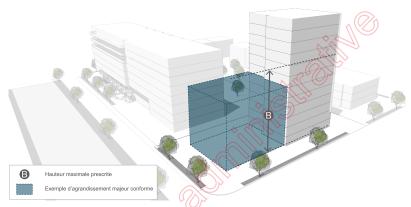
Agrandissement majeur d'une construction dérogatoire à la hauteur maximale
